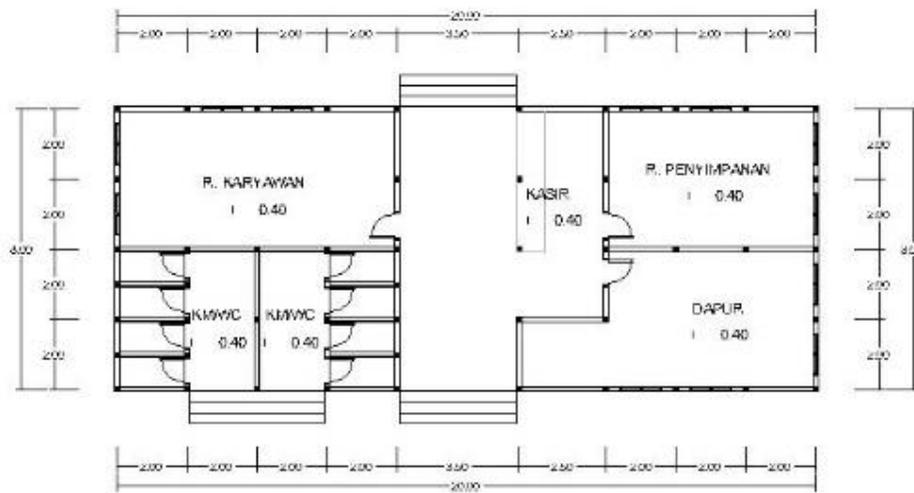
Denah Lantai 1 bangunan balai pertemuan
